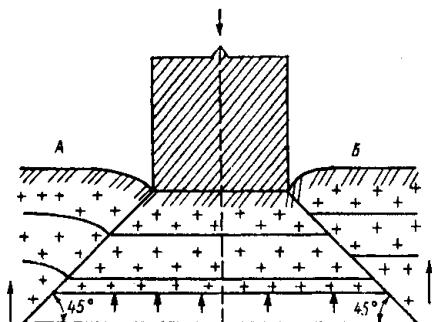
Расчетная схема устойчивости фундамента на действие нормальных сил морозного выпучивания
